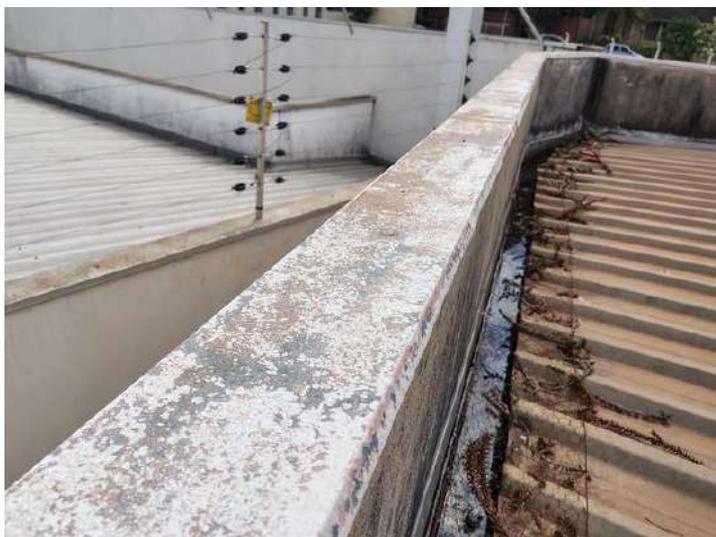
Cobertura Auditório – Deterioração da pintura dos rufos metálicos
